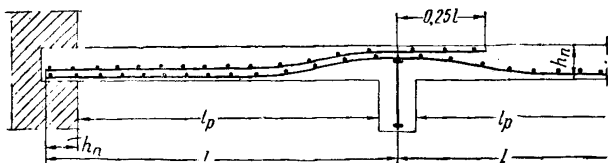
Армирование крайнего пролета плит сварными рулонными сетками с продольным расположением рабочих стержней
